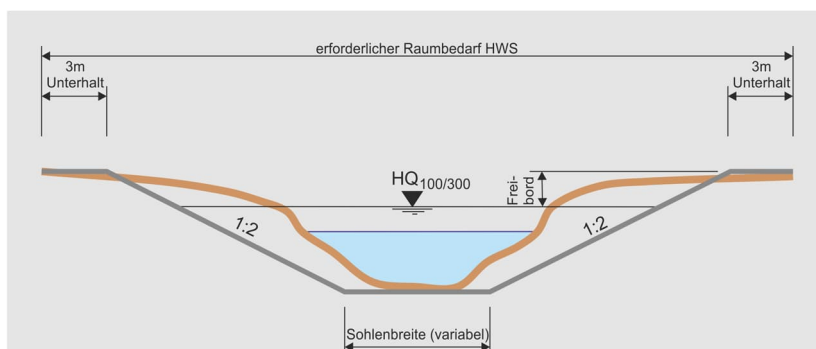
Querprofilbetrachtung für das offene Gerinne (Quelle: [www.gewaesserraum.ch](http://www.gewaesserraum.ch))
